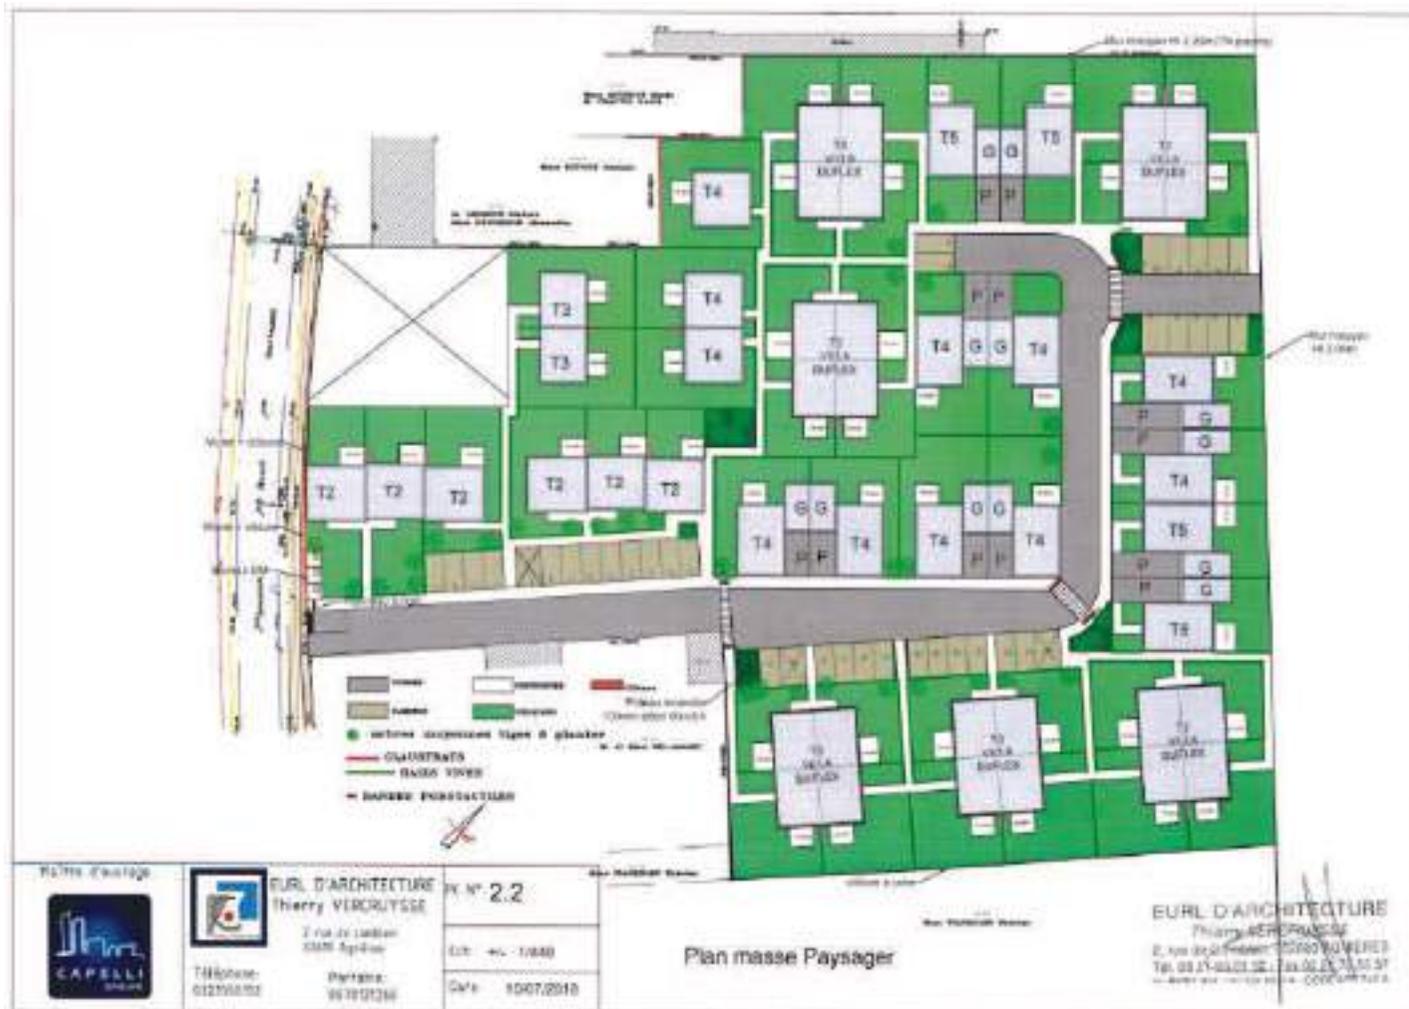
plan d'aménagement du site (source : CAPELLI / EURL D'ARCHITECTURE Thierry VERCRUYSE)
